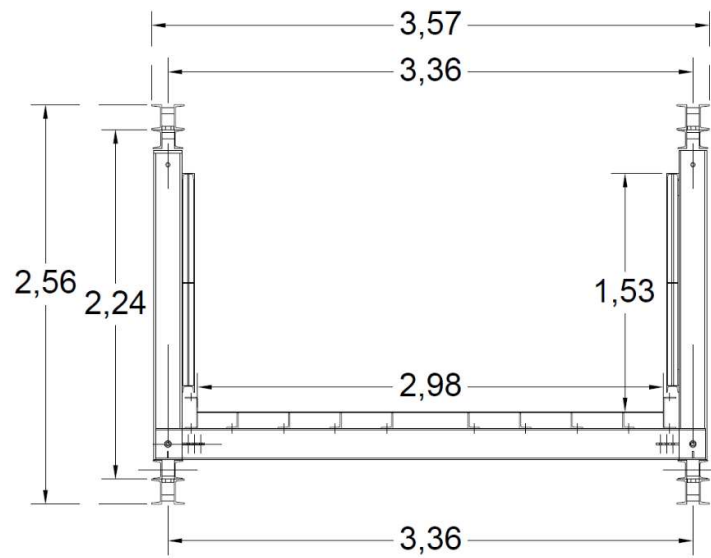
Sezione Trasversale Tipo in Mezzeria
